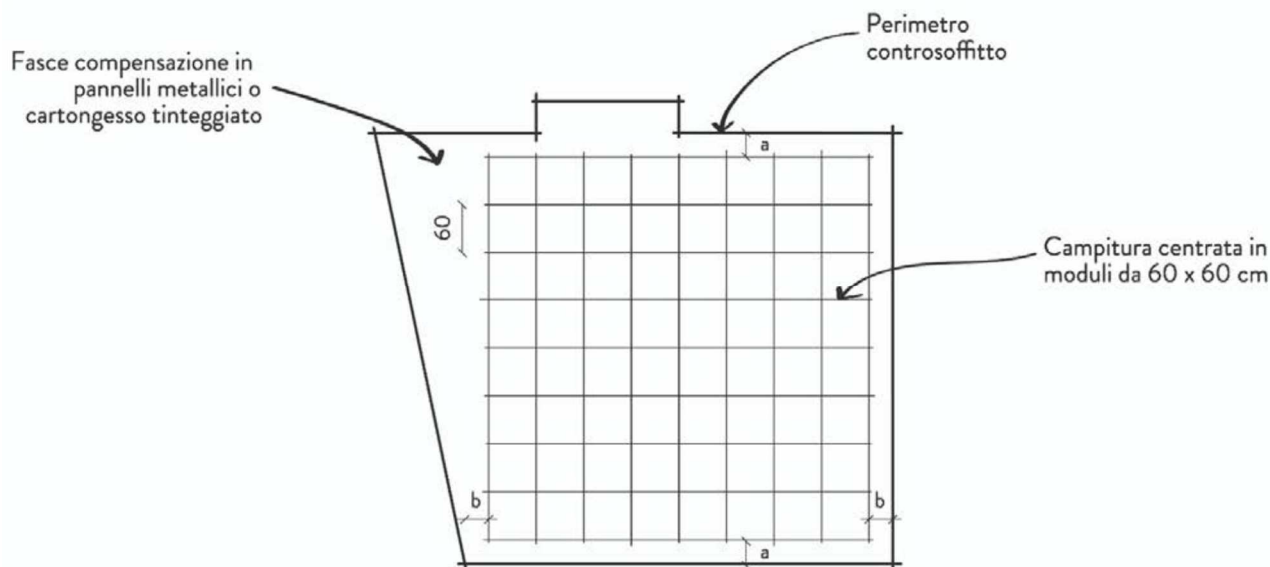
Schema di disposizione dei pannelli a controsoffitto
